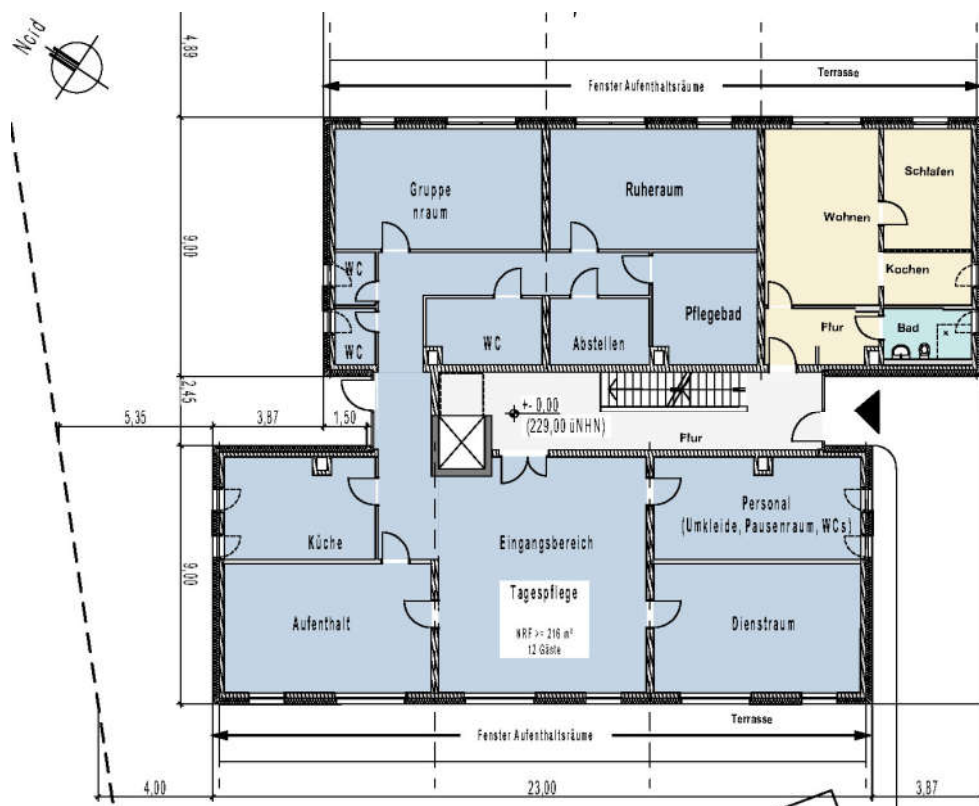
Grundriss Erdgeschoss / Betreutes Wohnen - Tagespflege
